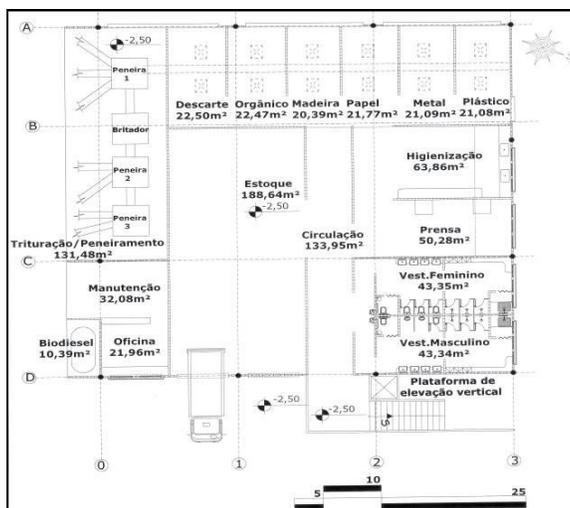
Galpão de Armazenamento, Triagem e Reciclagem – Planta baixa do subsolo.
